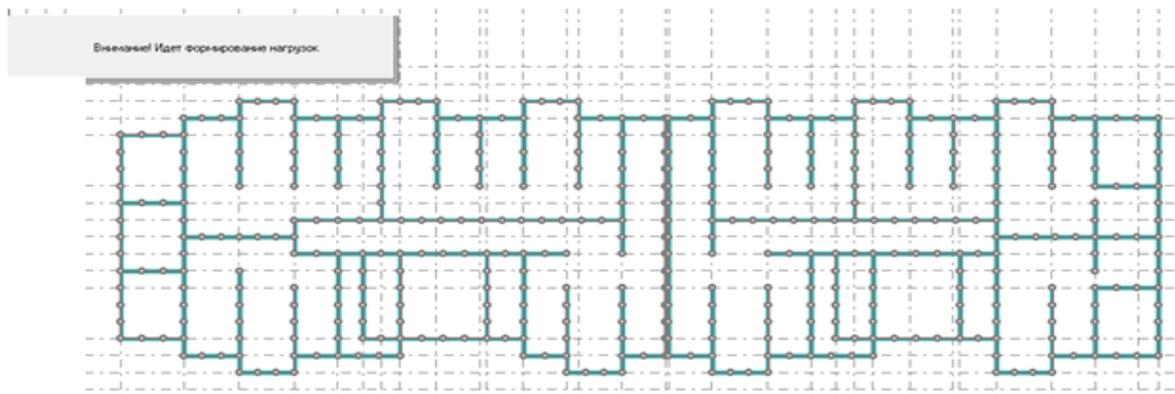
Схема расчета плиты перекрытия типового этажа
